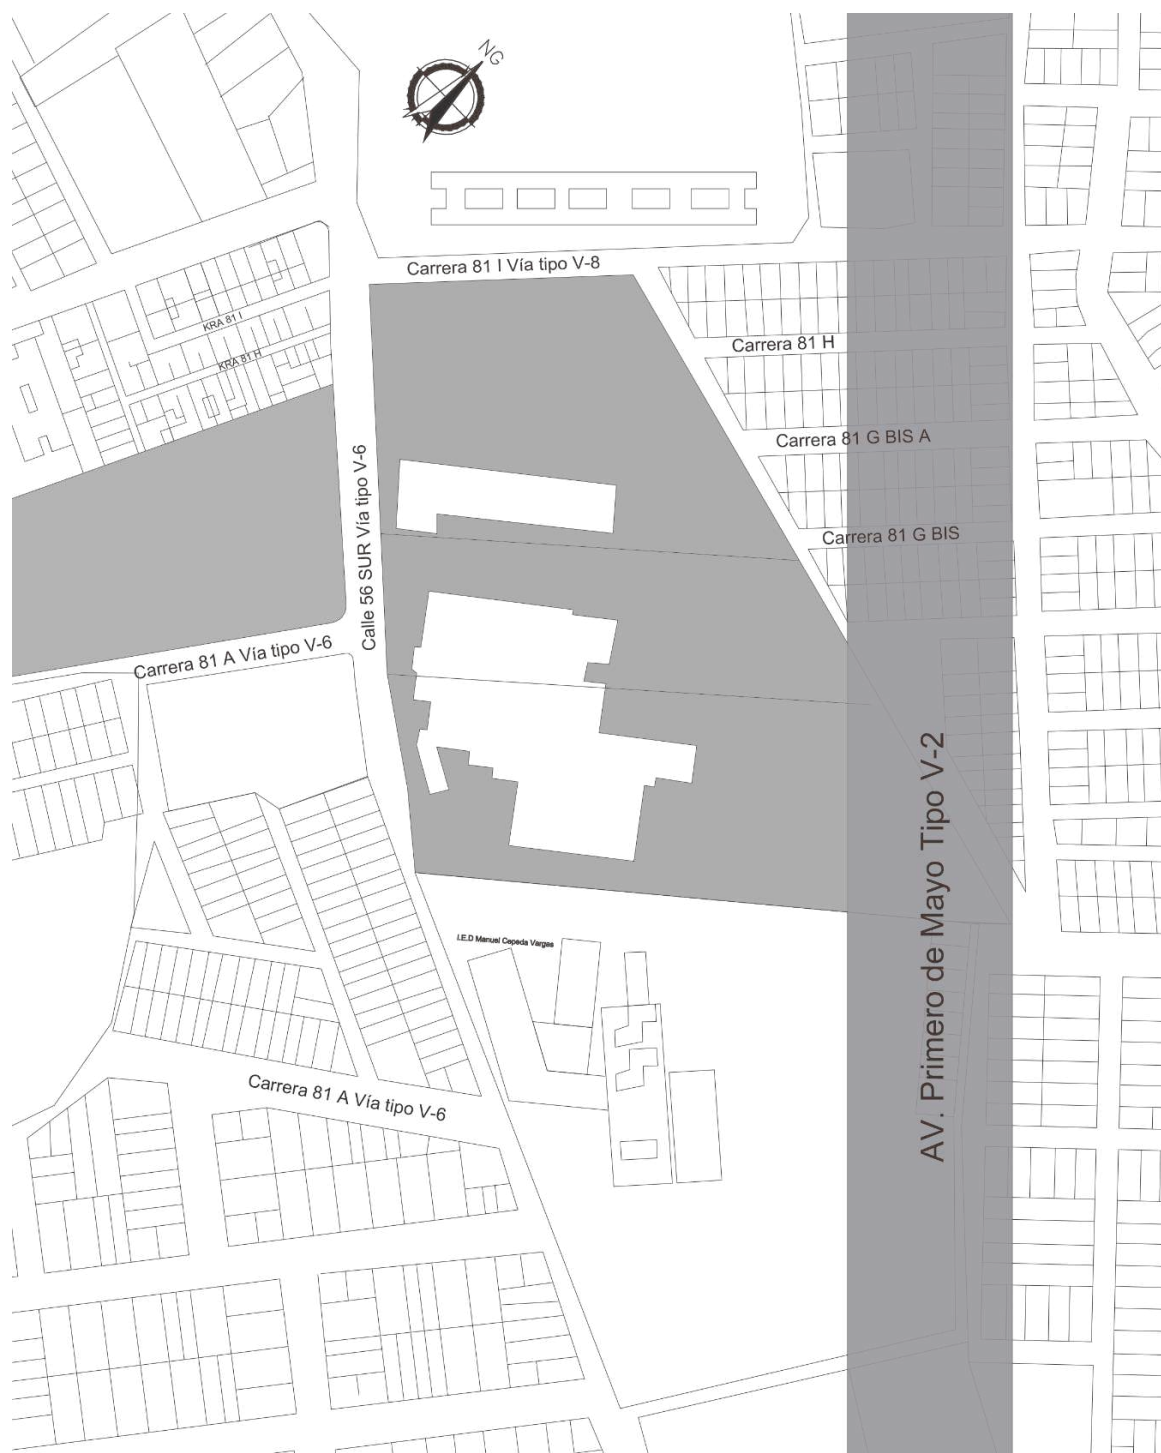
Plano del lugar de intervención, proyección reserva vial AV. Primero de mayo.
